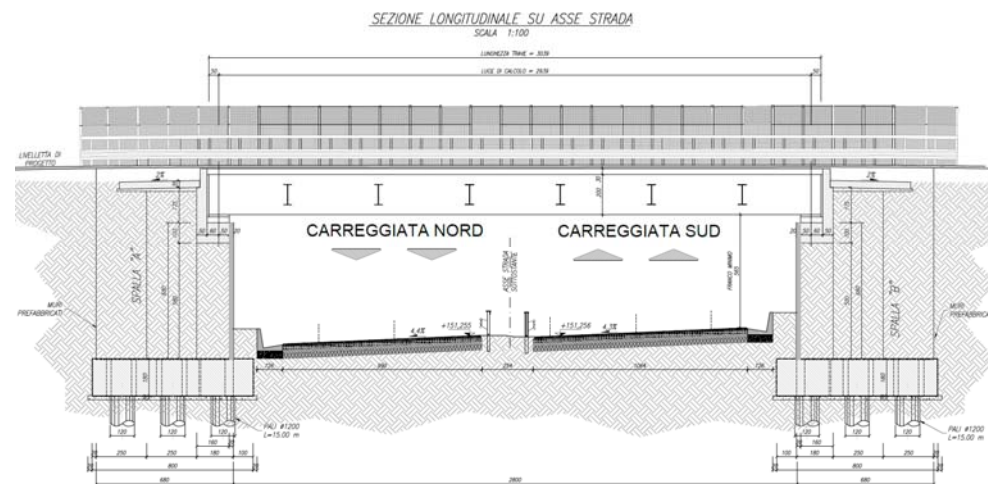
Cavalcavia al Km 9700: Sezione Longitudinale
